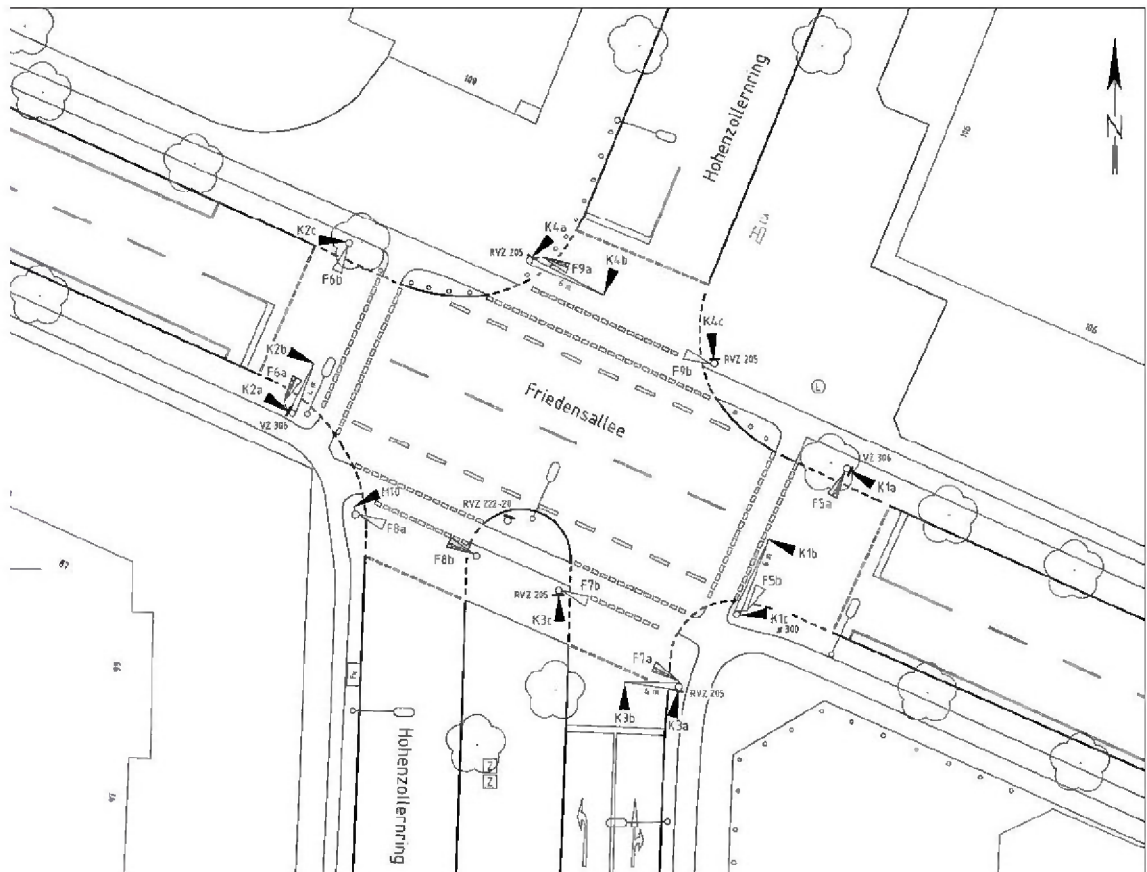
Signallageplan Friedensallee/Hohenzollernring – Bestand (17/617-04-06/00)
